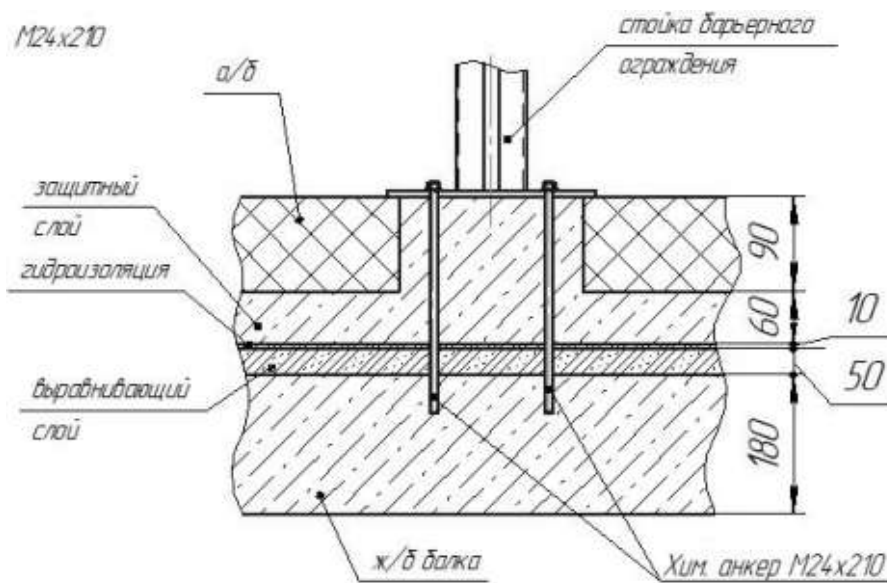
Крепление стоек на мостовом полотне с помощью химических анкеров
